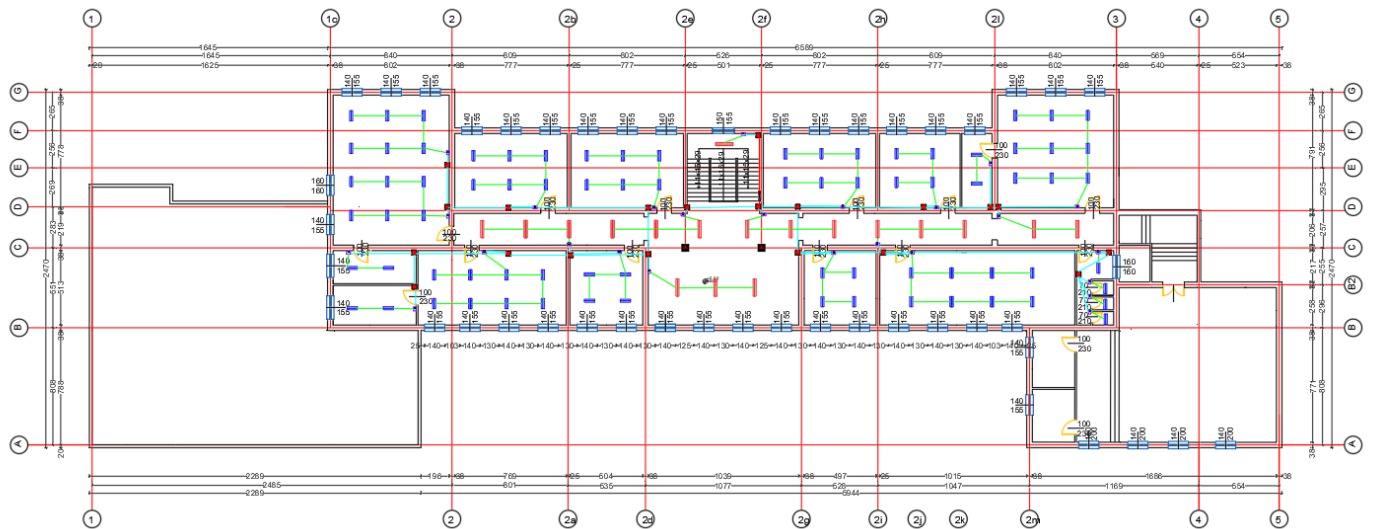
Planimetria e instalimeve elektrike, kati i II-re
